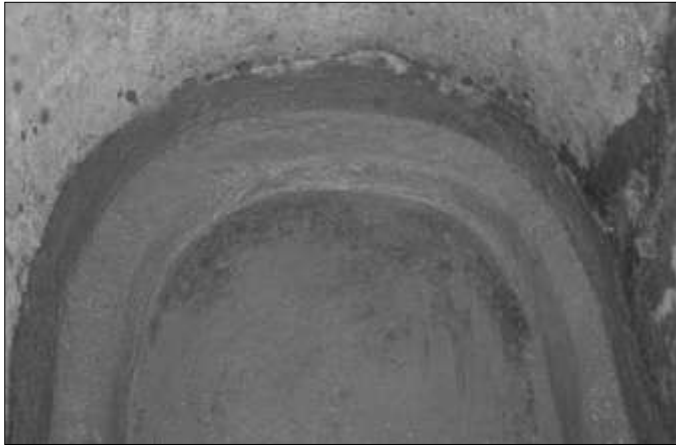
Particolare dello zoccolo di raccordo tra pareti e fondo della cisterna 1 (foto dell'autore).
